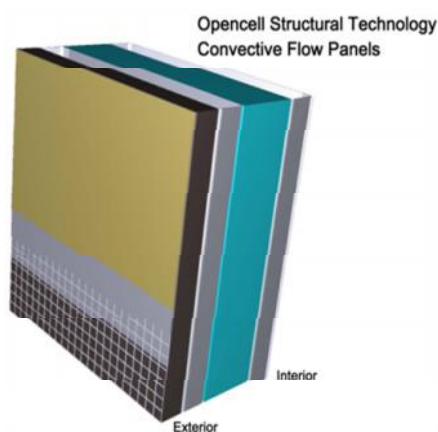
Sistema WALLINBLOCK (ITECONS, 2010)
